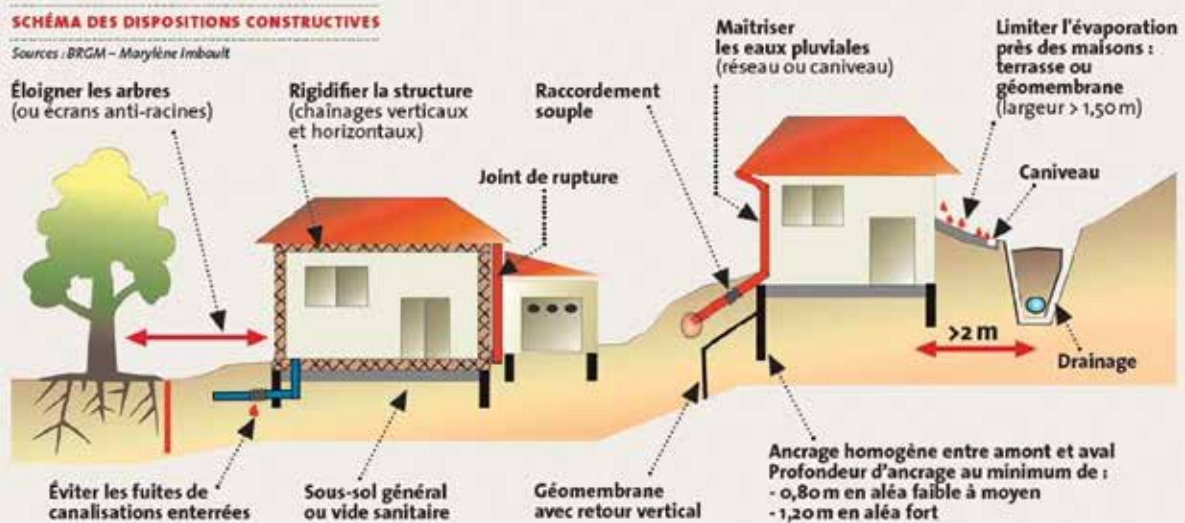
Dispositions constructives pour le bâti implanté en zone de RGA (Source : BRGM)
